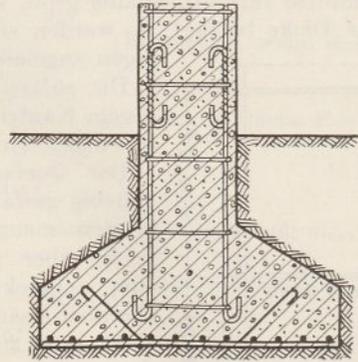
Fundamentplatte einer Eisenbetonsäule.
